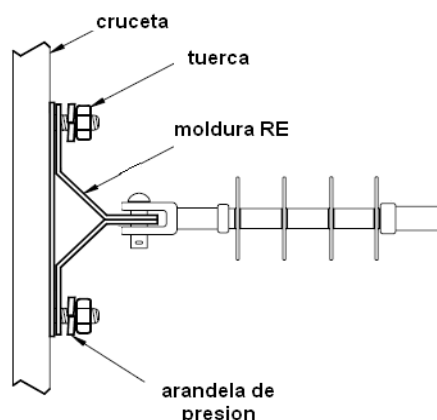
DETALLE INSTALACION MOLDURA RE
